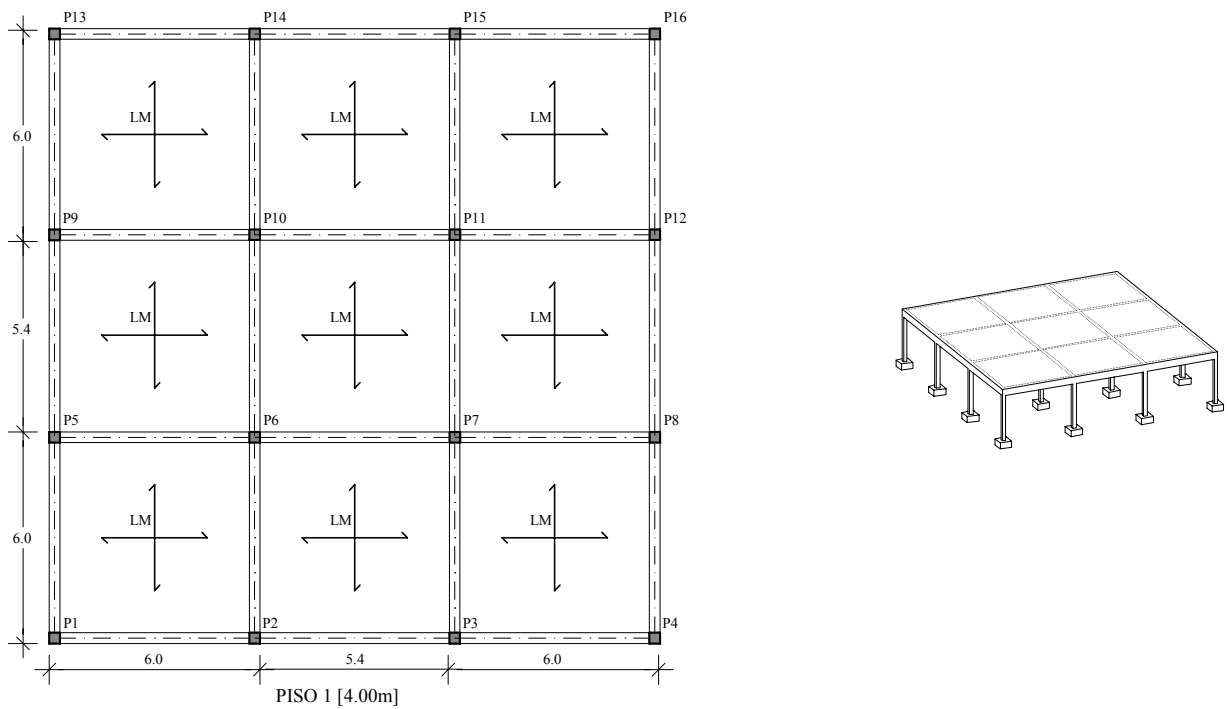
Planta estrutural e perspectiva da estrutura 1.
